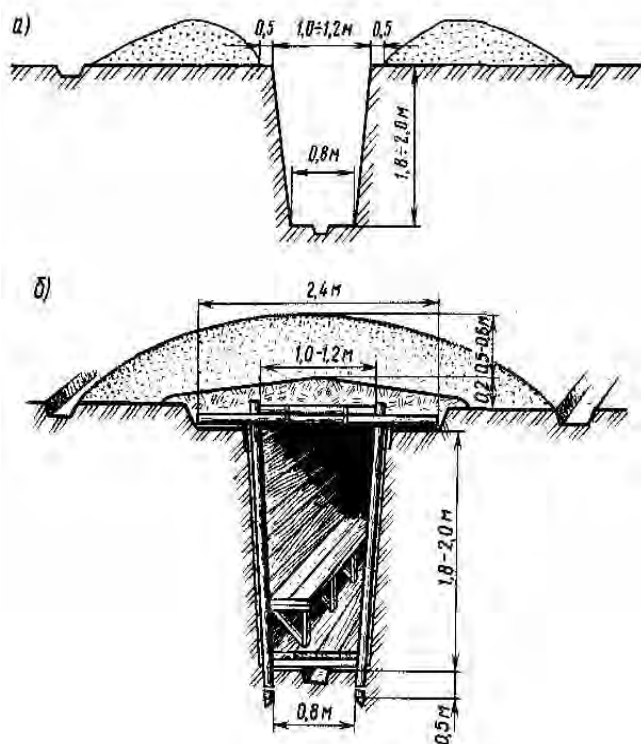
Открытая щель (а), перекрытая щель (б).
